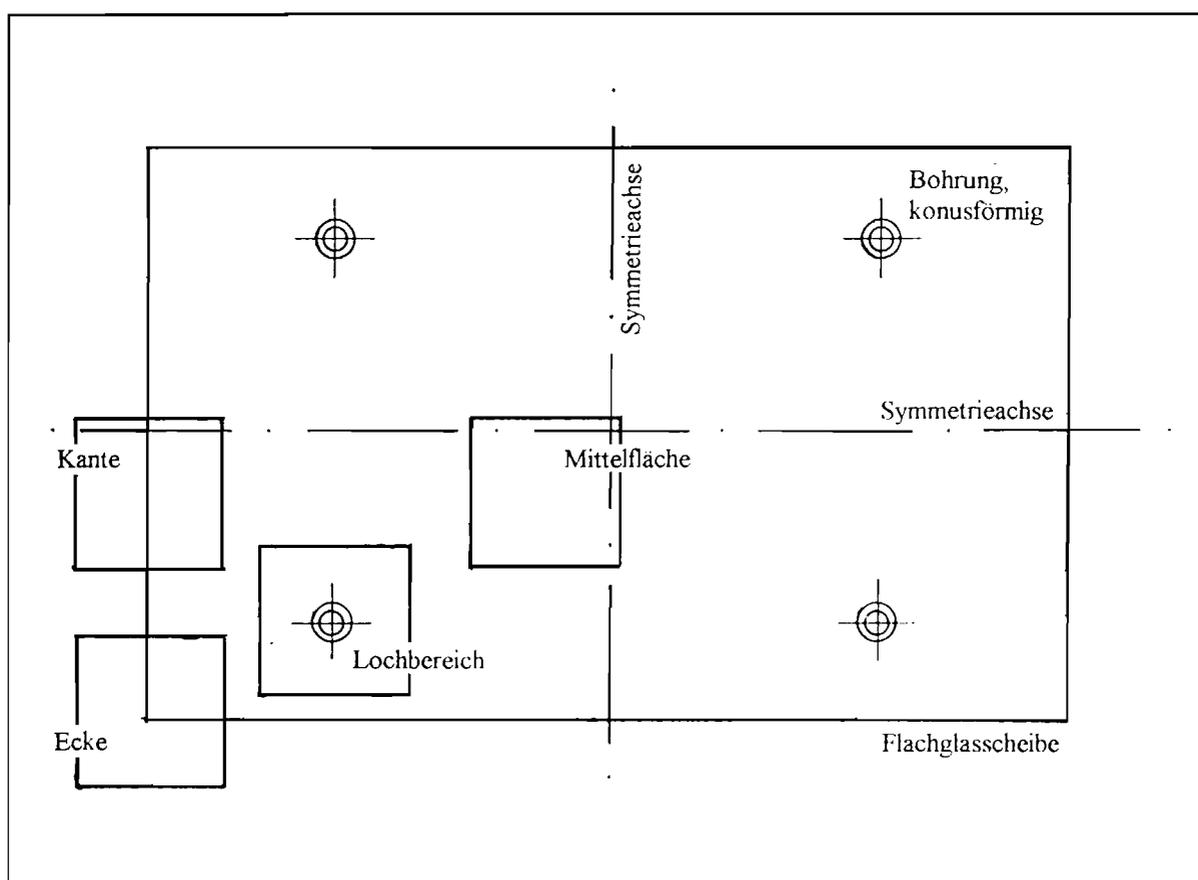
Grundriß und relevante Teilbereiche der Glasscheibe
